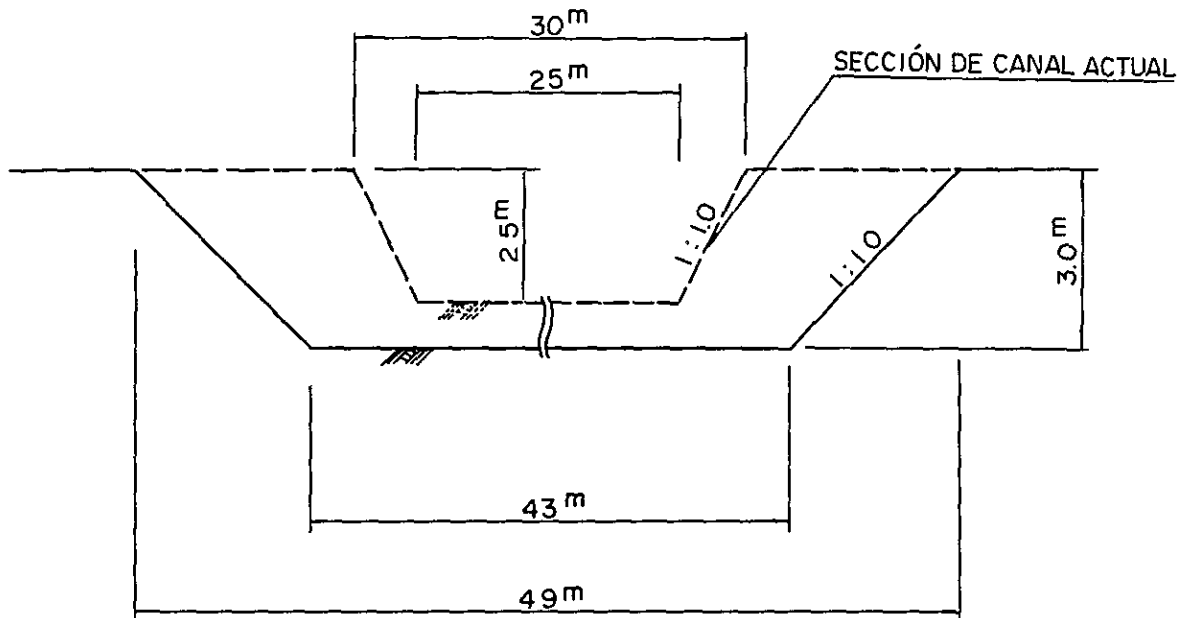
PLAN DE AMPLIACIÓN DE AQ SURUBIY
